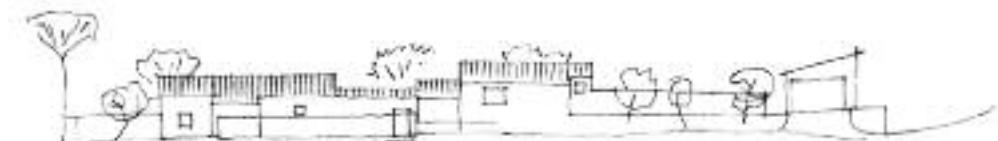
Bernard Rudofsky, fachada muro en la arquitectura rural mediterránea española: Menorca, circa 1967.
